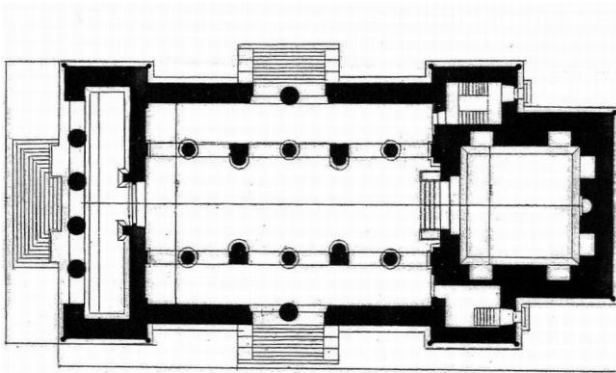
Grundriss Mausoleum Schilizzi. Neapel. 1880
